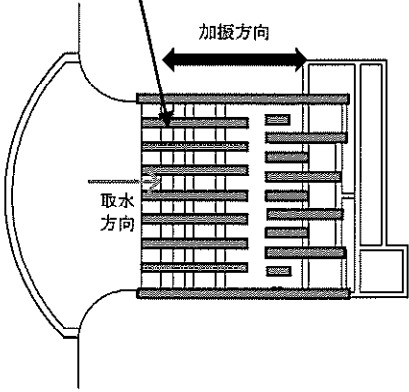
(2) 取水構造物の平面配置図（拡大図）
